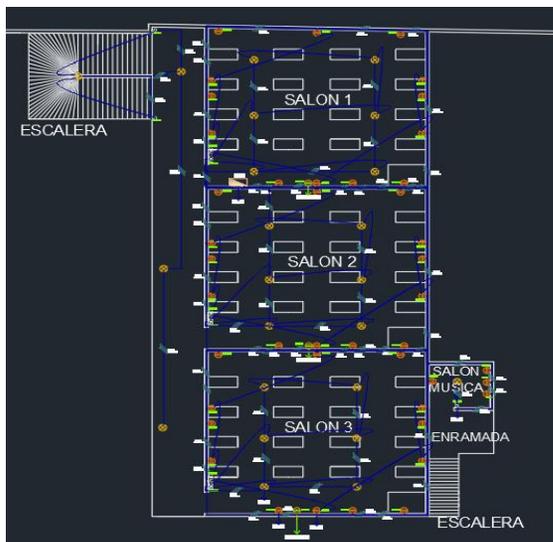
Plano eléctrico del primer piso trazado en AutoCAD
